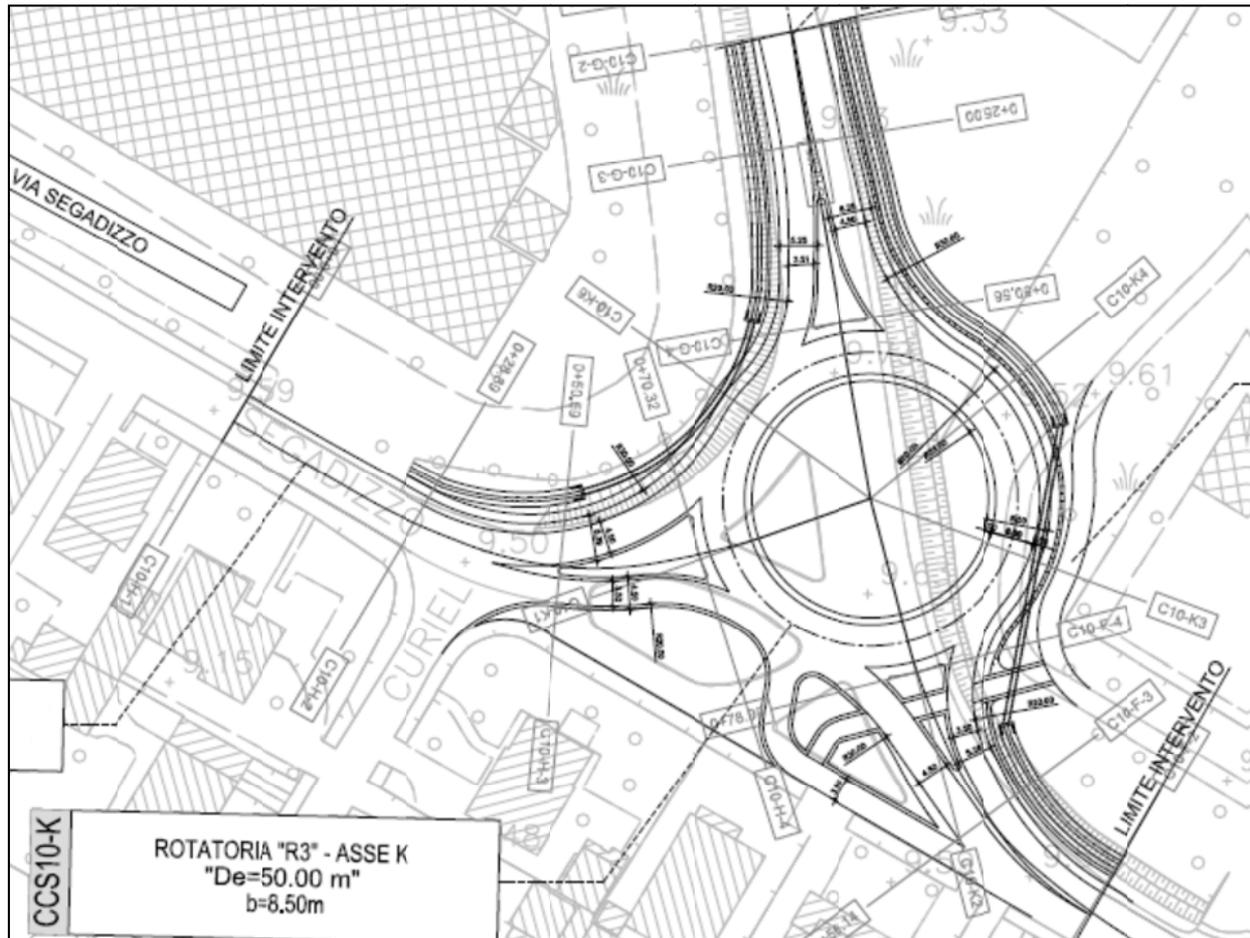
STRALCIO PLANIMETRICO ROTATORIA C10-R3
